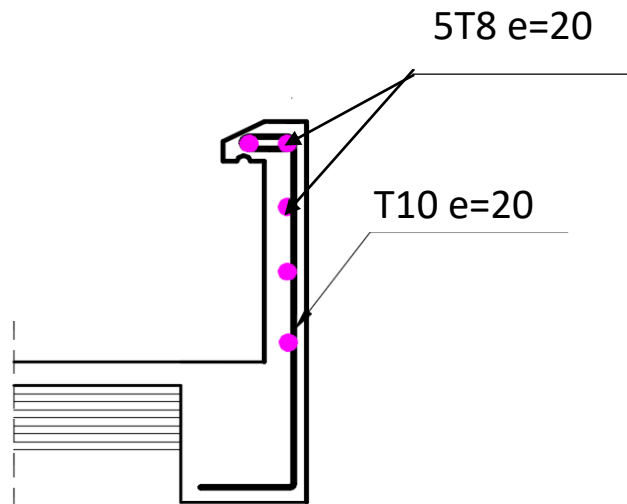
schéma de ferrailage de l'acrotère.
